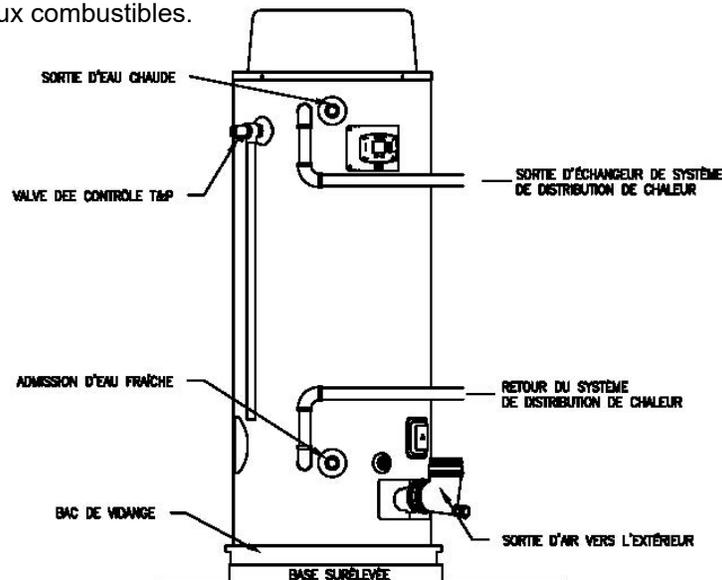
Autres possibilités de raccordement hydraulique pour réchauffement d'espace
